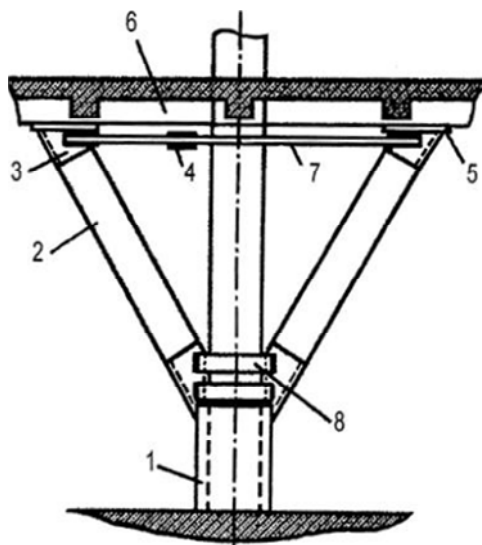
Усиление с частичным разгрузением конструкции (дополнительная жесткая опора – сборные железобетонные подкосы):
